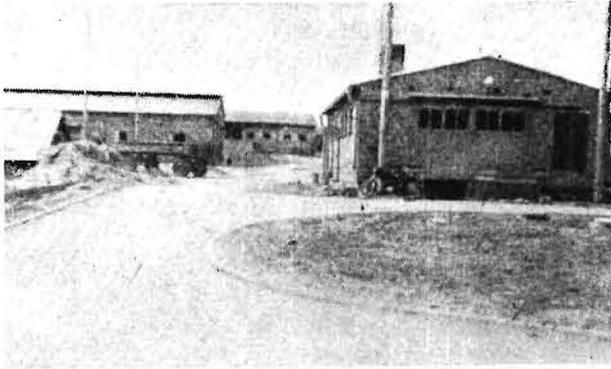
Rinderstallanlage mit Melkhaus. Zufahrtstraße zu diesem Stallkomplex der LPG Bad Tennstedt mit Kupferschlackensteinen befestigt, Wege zwischen den Ställen Packlage mit feucht eingewalzter Kiesschicht, Wege zu und vom Melkhaus betoniert...
